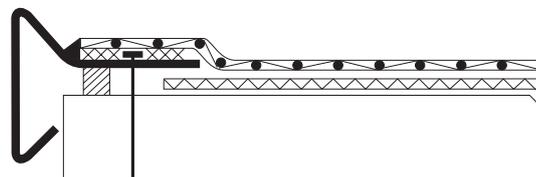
Randfixierung mit RENOLIT ALKORPLAN Verbundblech und Winddichtungsband
